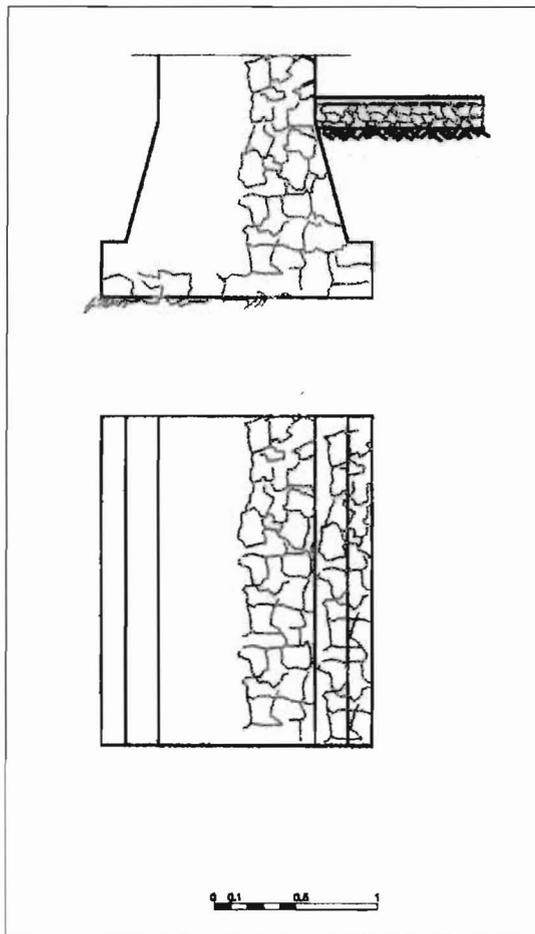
Sección de la cimentación corrida de los muros de fachada.
